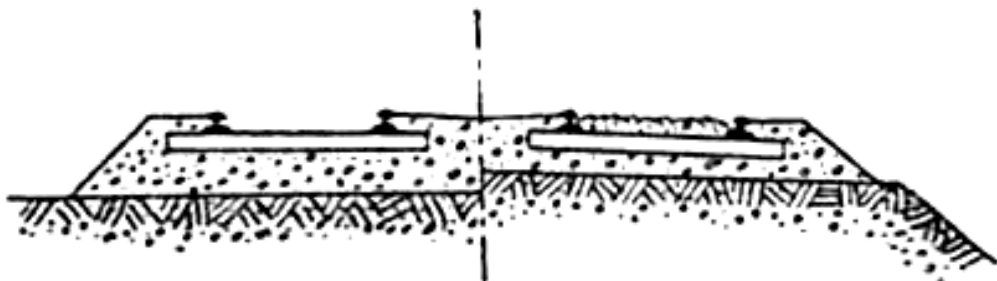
Secciones transversales de vía, con durmientes al descubierto, en el primer caso y cubiertas por el balasto en el segundo.
